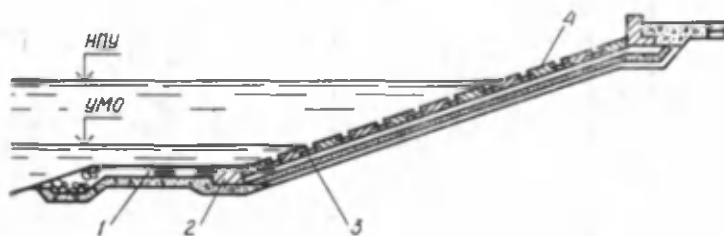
Конструкция сборного сквозного крепления из железобетонных плит: 1 — облегченное крепление; 2 — упор основного крепления; 3 — подготовка слоистая или однослойная; 4 — основное покрытие из плит с открытыми швами
